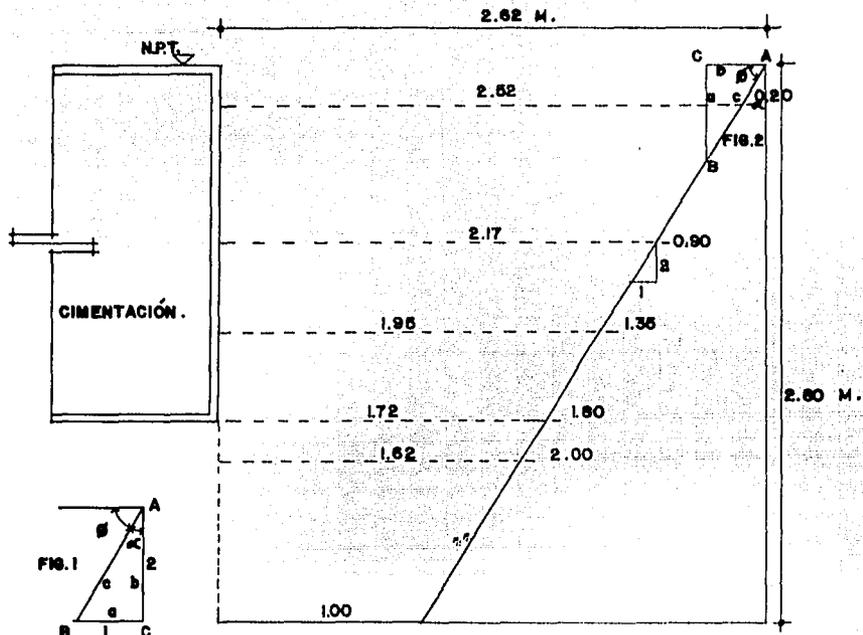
DREN AL FONDO DE LA EXCAVACIÓN.
